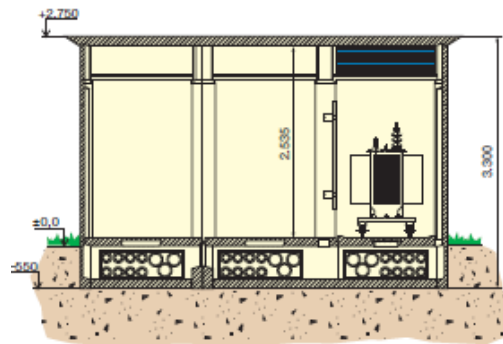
Centro prefabricado de hormigón EHC4, Schneider. Fuente: Ficha técnica de Schneider
